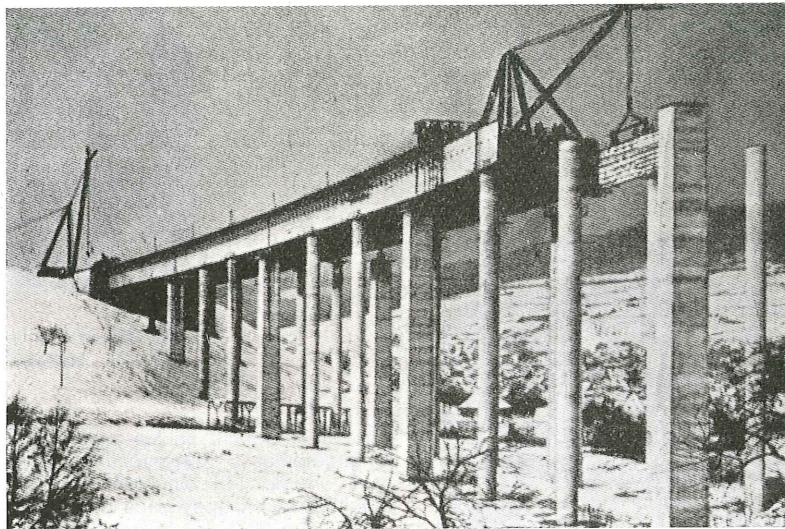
Vista de la construcción del puente de Kauppen. Esta solución ganó un concurso entre 67 proyectos. El puente consta de 6 vanos de 60-65 y 70 m de luz, con una longitud total de 390 m. Durante la construcción se colocaron apoos provisionales en puntos situados a los tercios de la luz.
